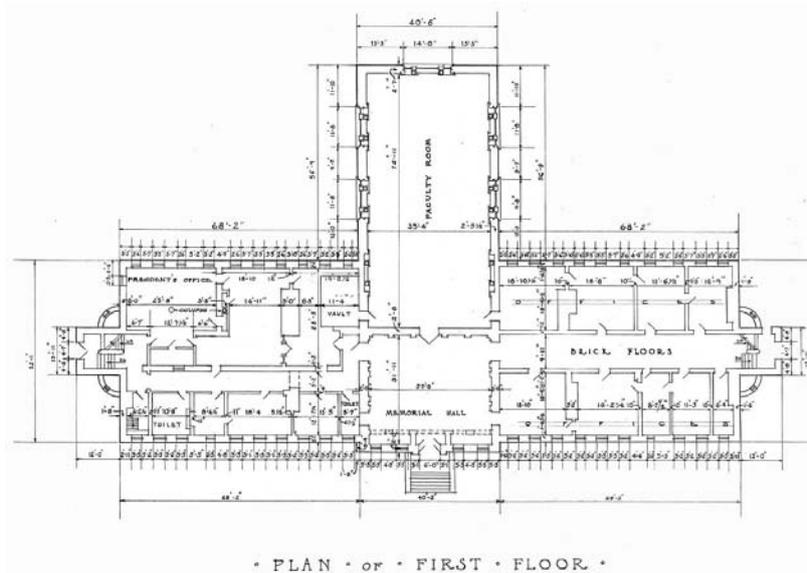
14: Nassau Hall Grundriss
